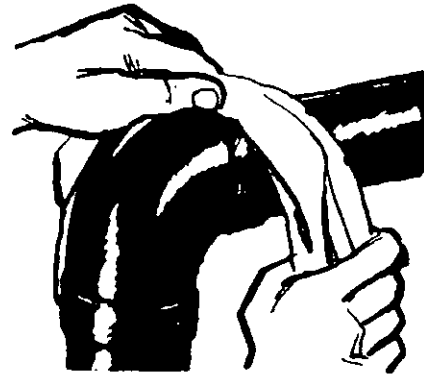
Alisamiento de la soldadura.
